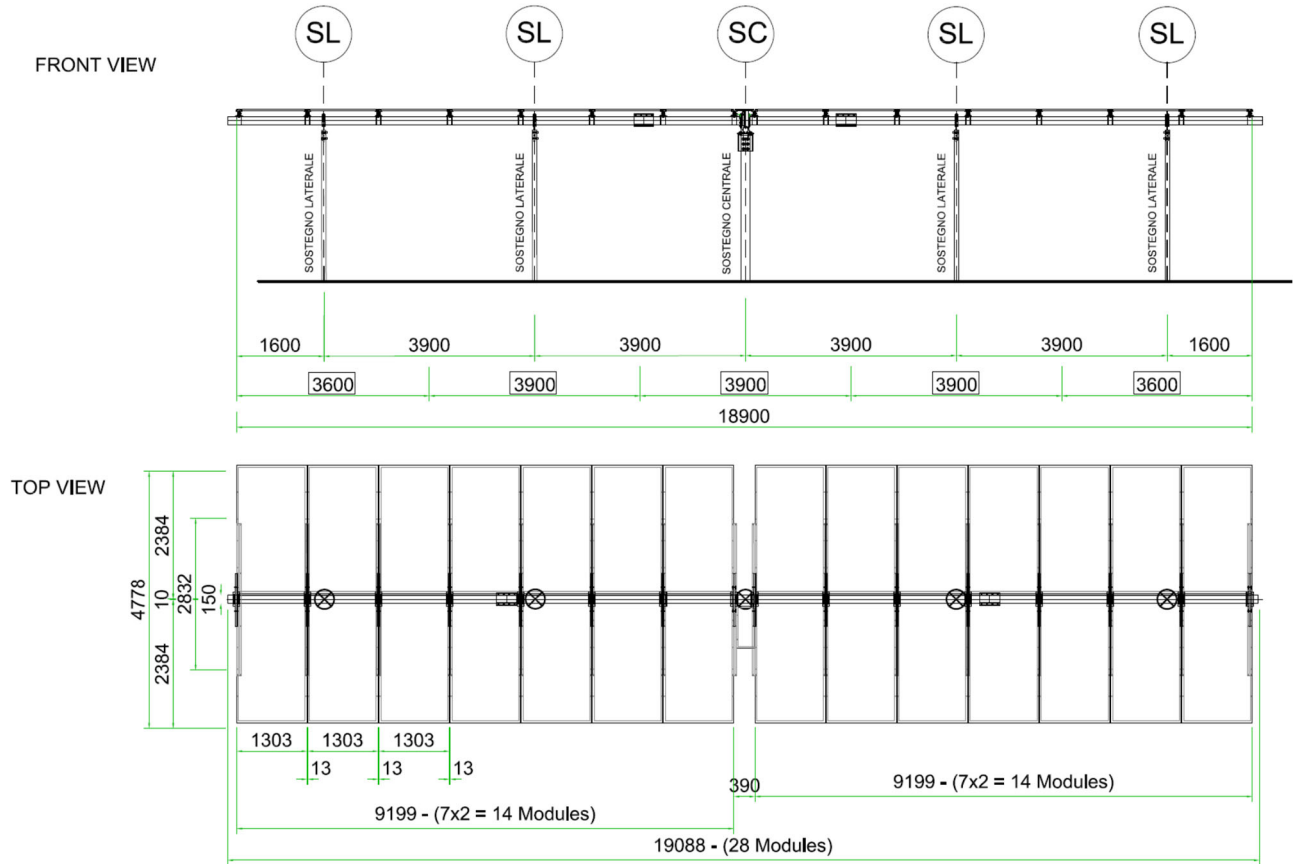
Prospetto e pianta dei Trackers a 5 supporti
